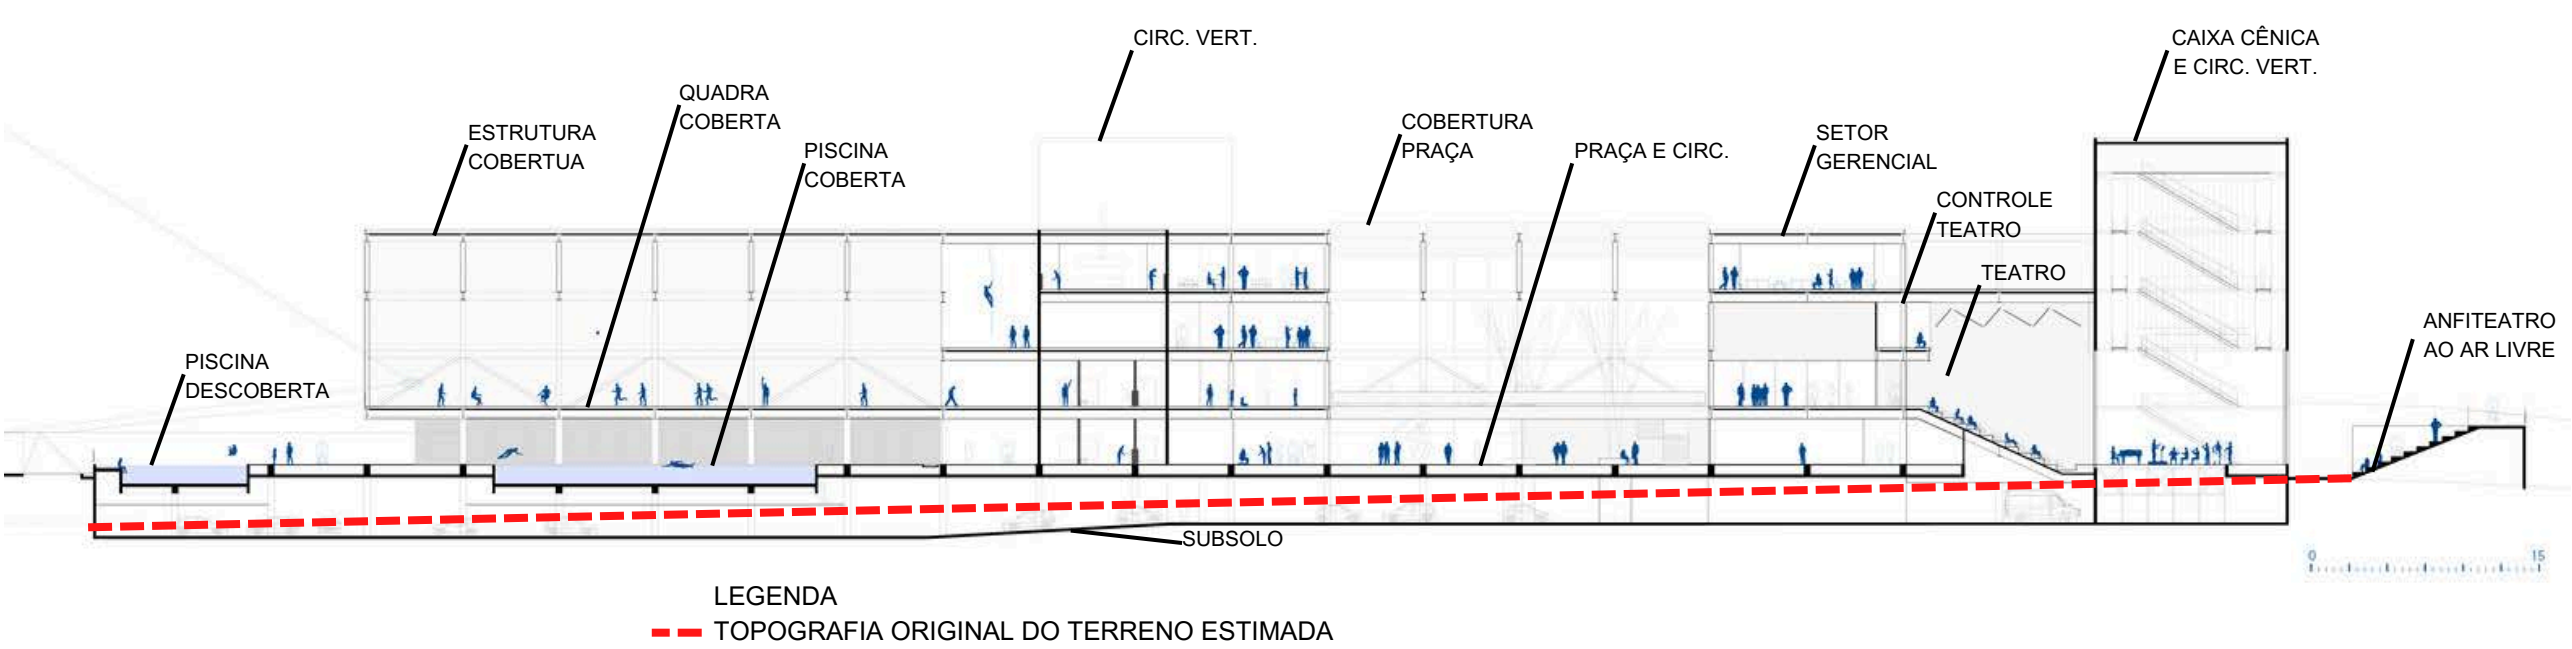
e 102: Plantas do projeto do Sesc Limeira. Archdaily, 2017.
